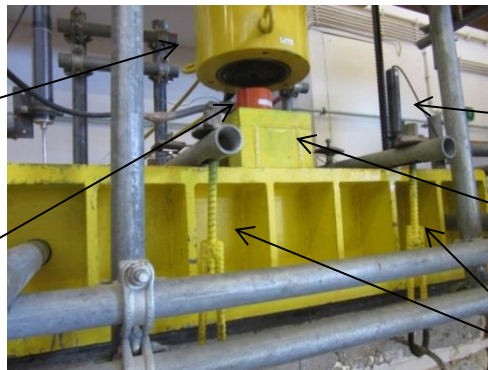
Murete M209 com as vigas metálicas que simulam o pavimento.
